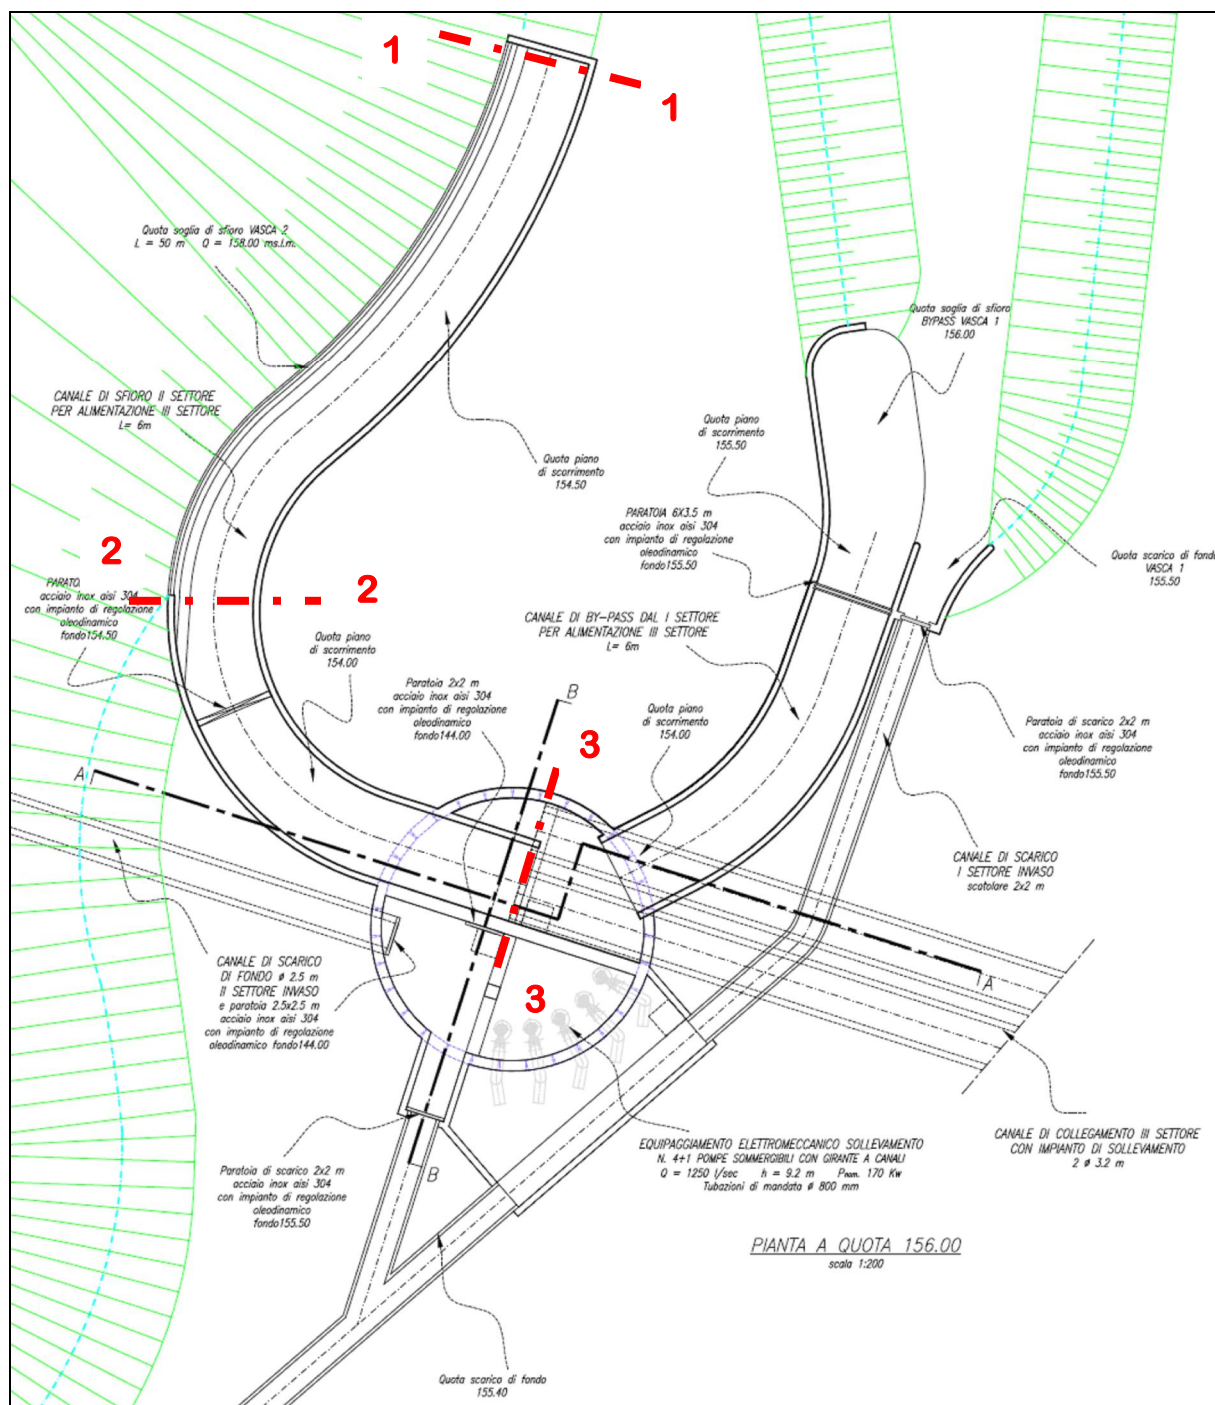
Planimetria della soglia di sfioro e del canale di gronda
